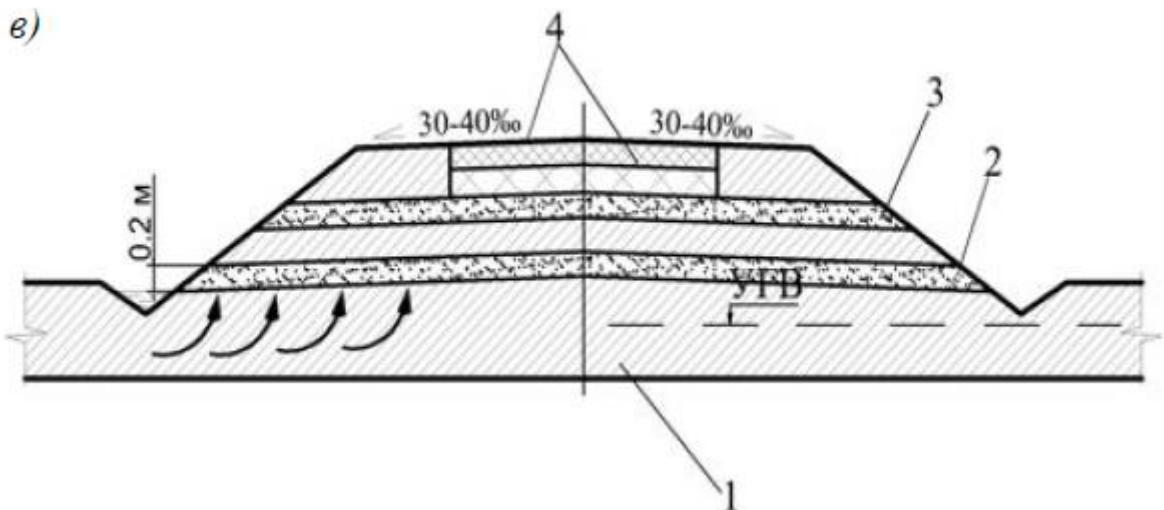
Конструкции земляного полотна с гидроизолирующими прослойками (ГП):
